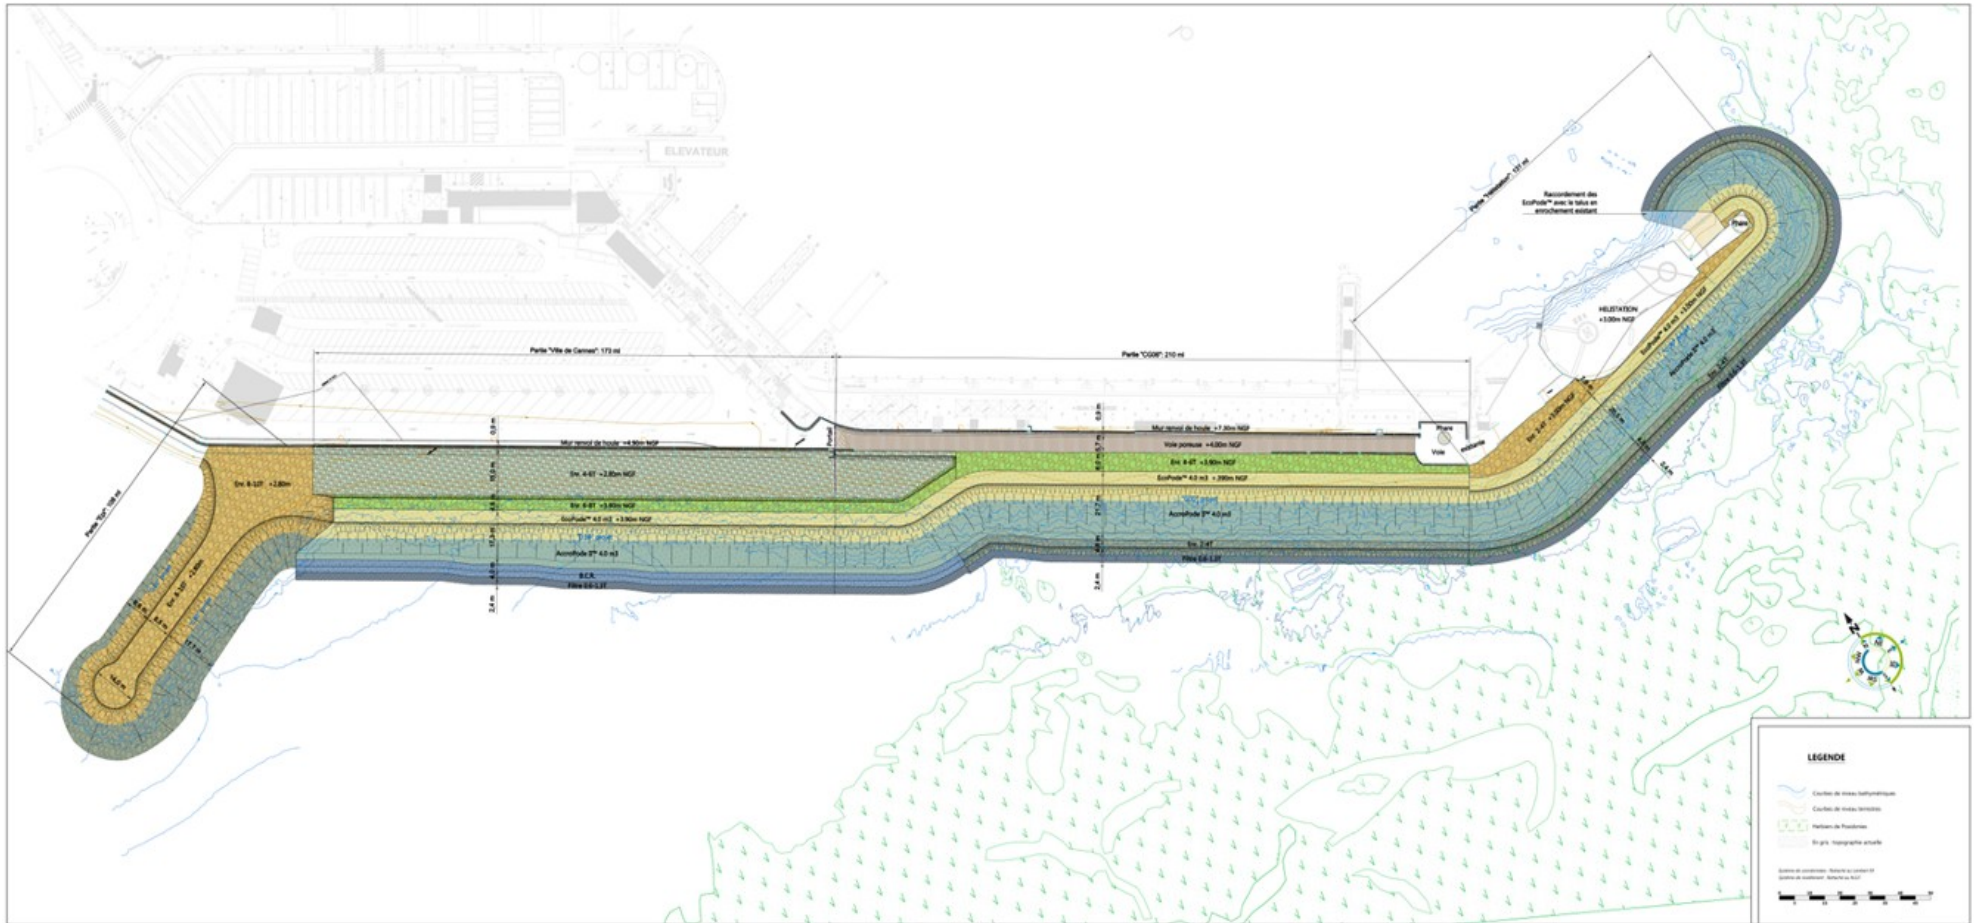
Coupe et plan masse du profil hélistation / musoir retenu (Source : ACRI-IN)
